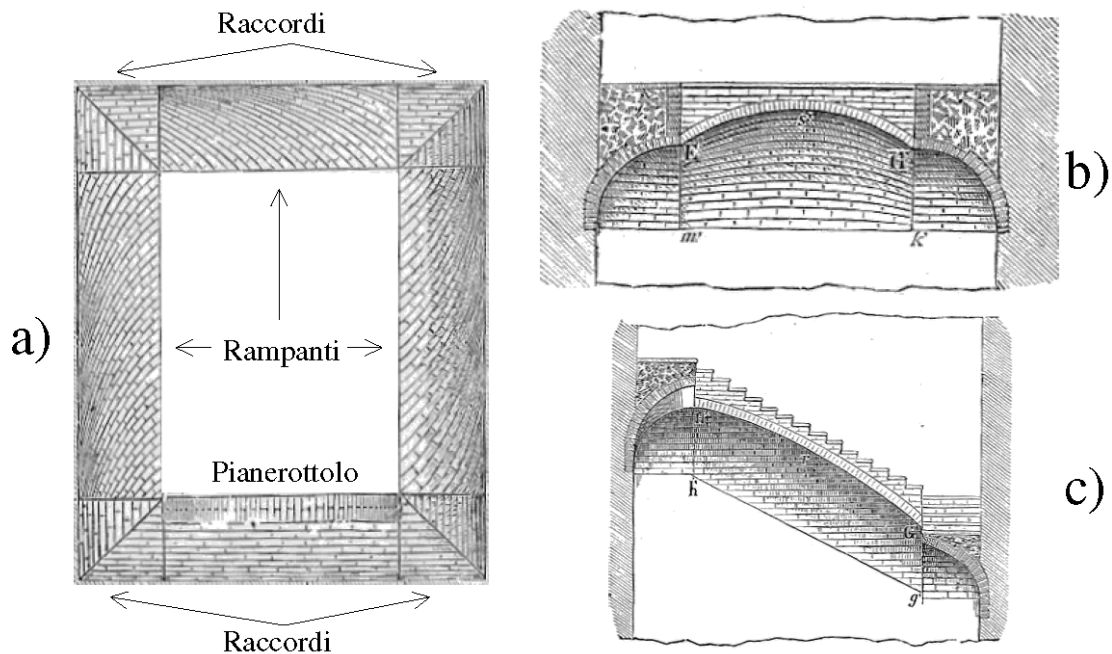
Morfologia della scala: a) pianta; b) sezione sul pianerottolo; c) sezione sul rampante
